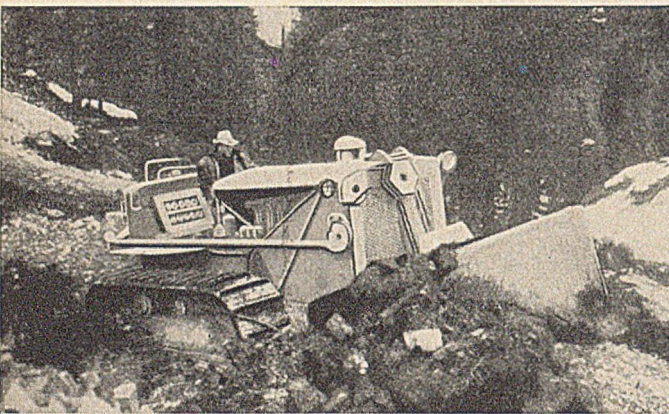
Caterpillar D8-Planiererraupe beim Aufbrechen gefrorenen Bodens mit einer Ecke des geneigten Planierschildes.
